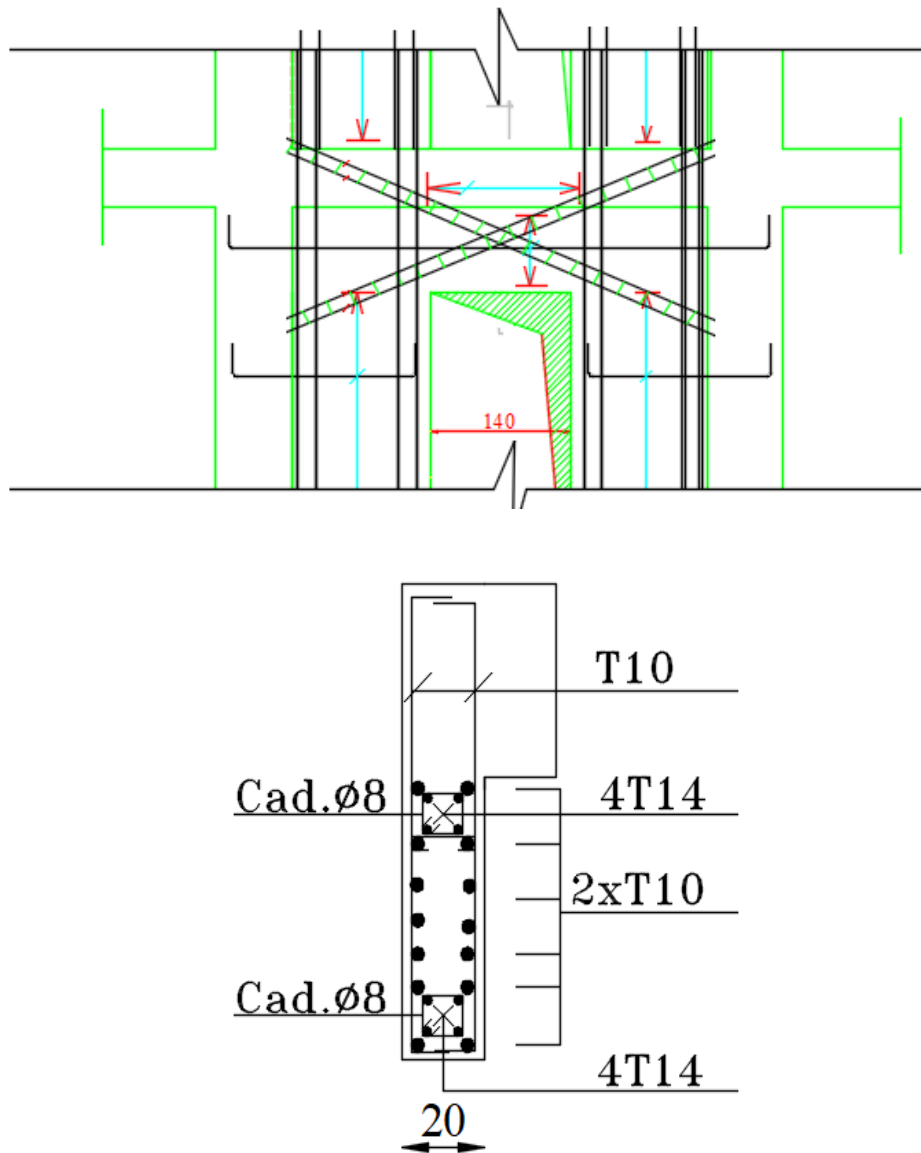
Ferrailage du linteau de voile du RDC.
